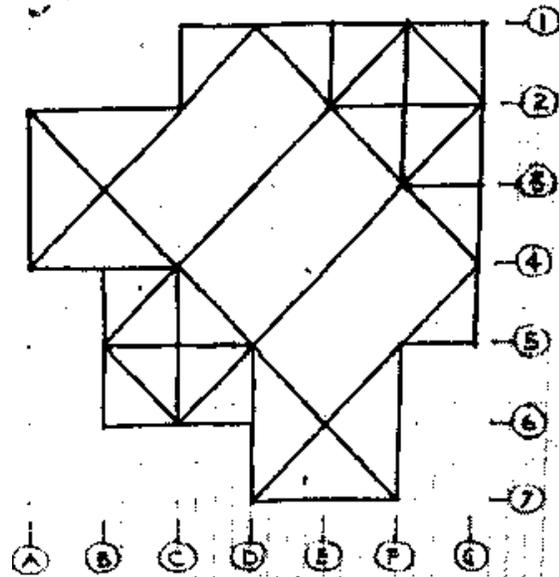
Planta del proyecto de la parroquia de San José, 1982. Jungapeo Michoacán. Fuente: AAM, FCM.
